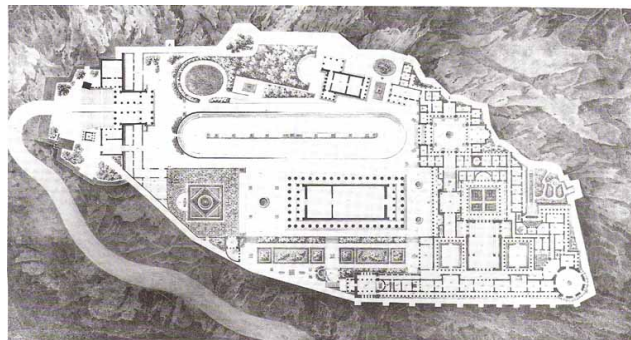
Grundriss des Entwurfs Schinkels<sup>4</sup>
